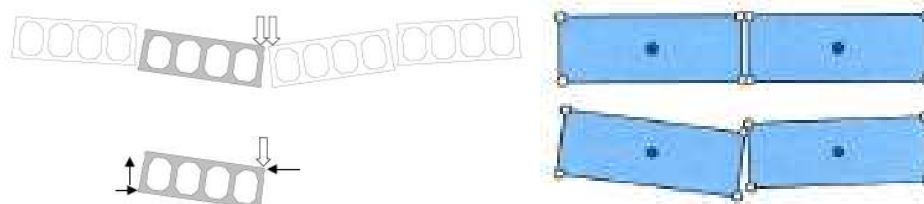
Mecanismo de distribución transversal. Cortesía de Lundgren
